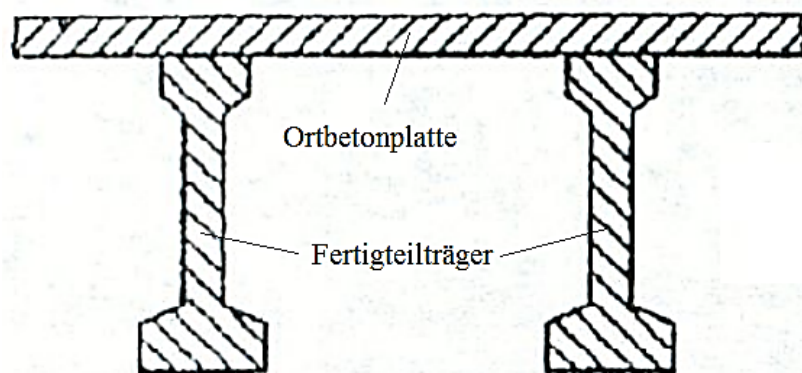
Mögliche Ausführung von Plattenbalken – Fertigteilträger und Ortbetonplatte<sup>18</sup>
